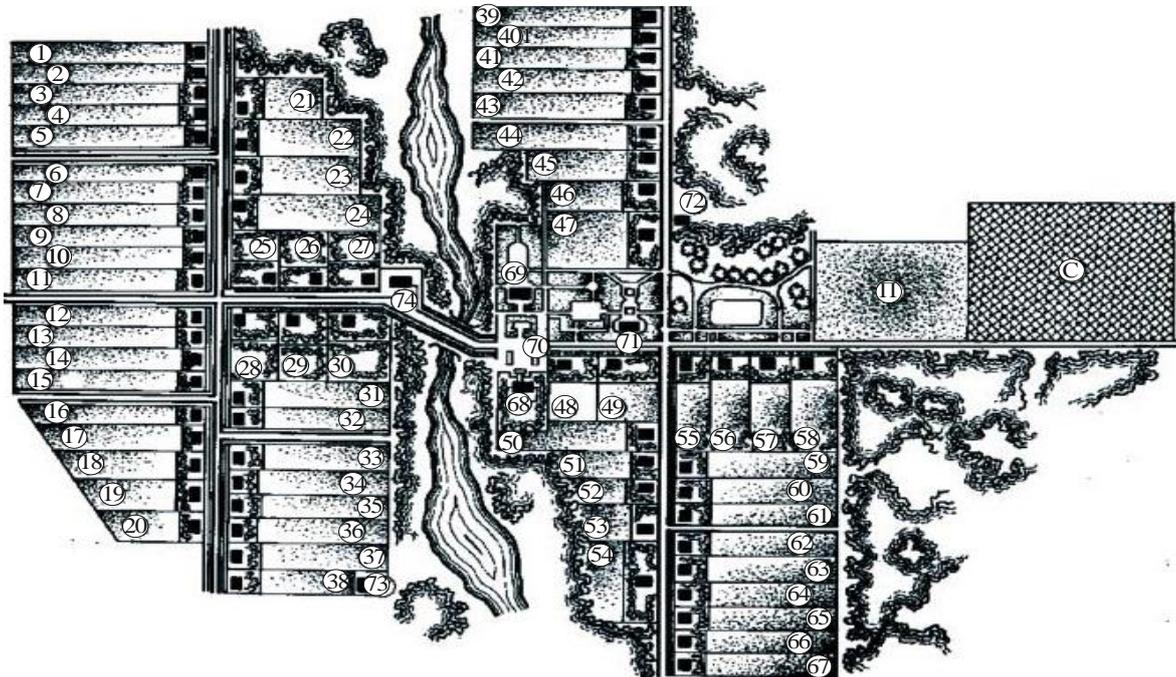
(начало) – Послевоенное строительство сел: А – схема планировки:
